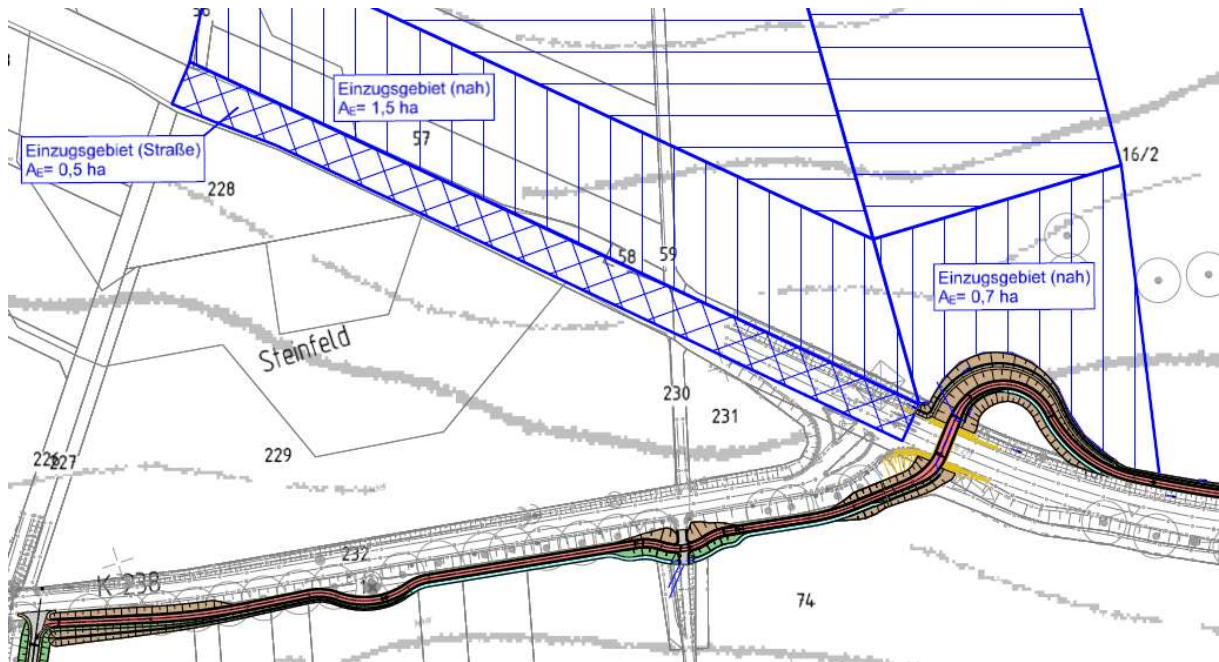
Ausschnitt Lageplan Entwässerung 2
